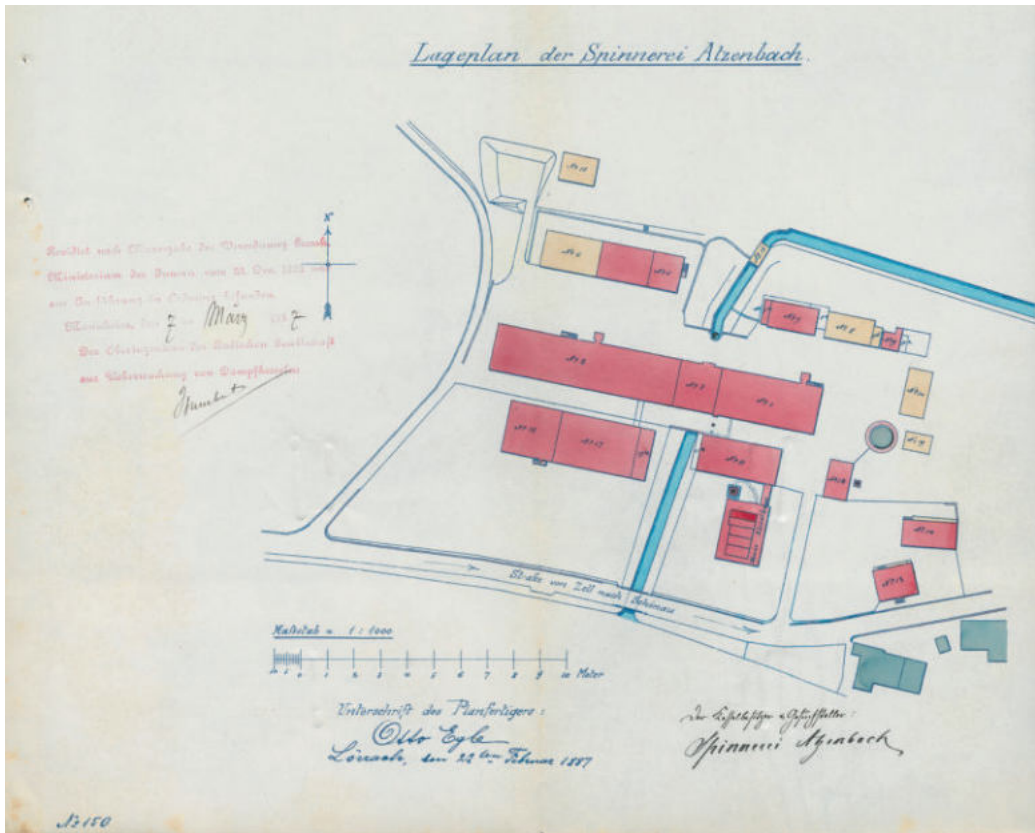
Der Situationsplan der Spinnerei Atzenbach aus dem Jahre 1887 zeigt den Hauptbau, umgeben von Nebengebäuden, darunter die Gasbereitungsanlage mit Gasometer (kreisförmiger Grundriss). StAF B 738/1, Nr. 82.
